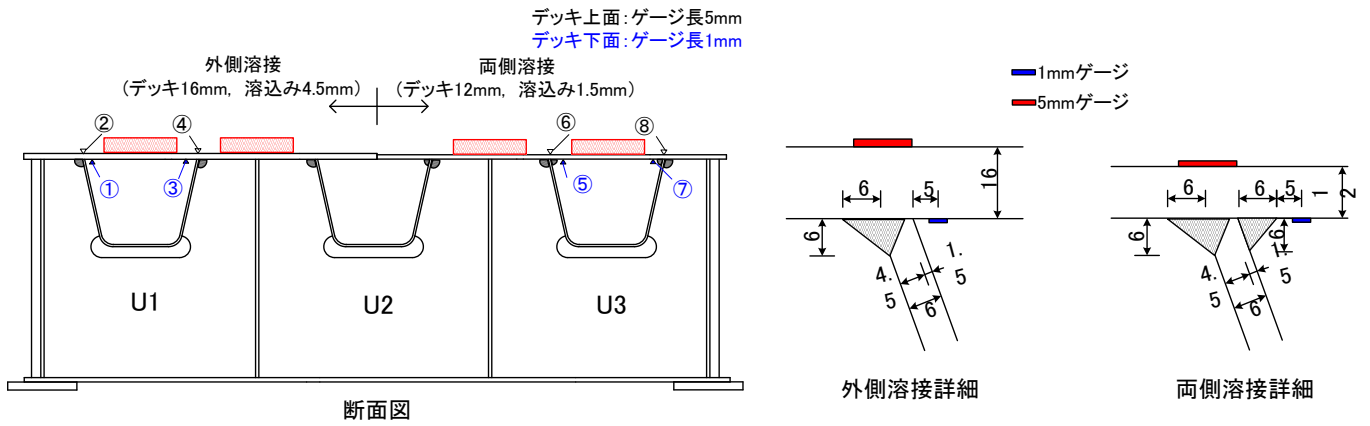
溶接部詳細およびひずみゲージ貼り付け位置
